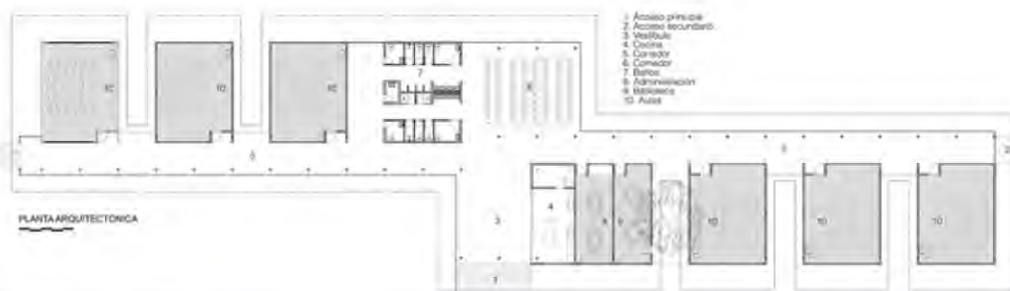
Planta arquitectónica escuela Waldorf Casa de las Estrellas. Fuente: Salagnac Arquitectos, 2020.
